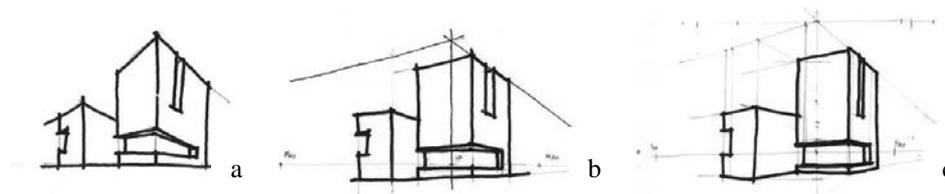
a) croqui não-estruturado, b) croqui semi-estruturado, c) croqui estruturado
